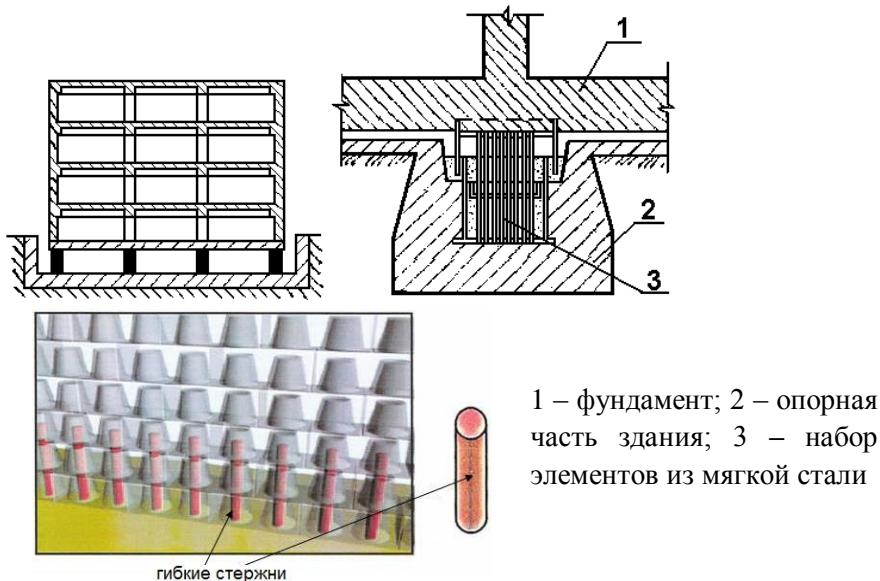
Конструкции опоры с гасителями колебаний в виде набора элементов, изготавливаемых из мягкой стали
